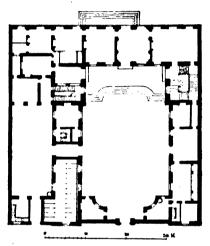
Hôtel Chevreuse zu Paris. Grundriss des Erdgeschosses.
